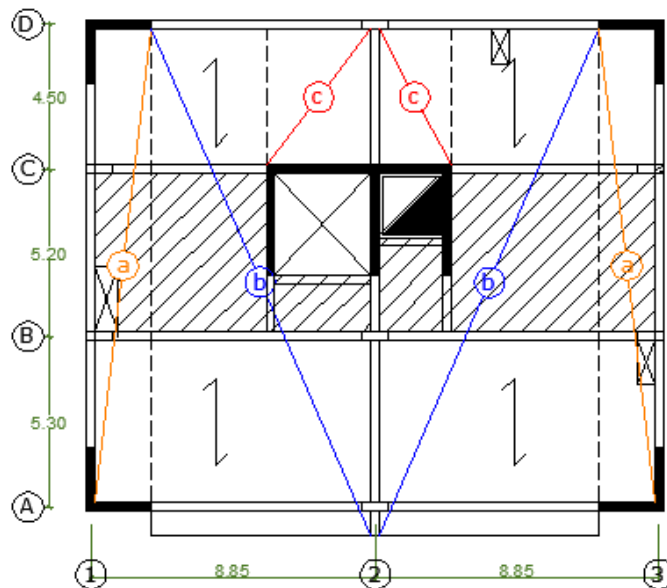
Tipos de losa en planta típica y octavo nivel (azotea)
